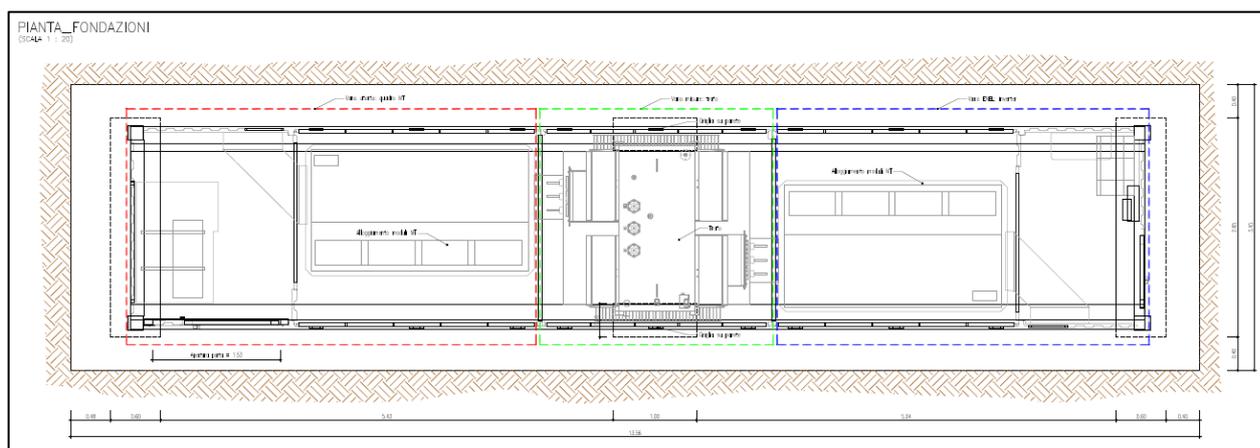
Pianta fondazioni di una cabina di campo e trasformazione
